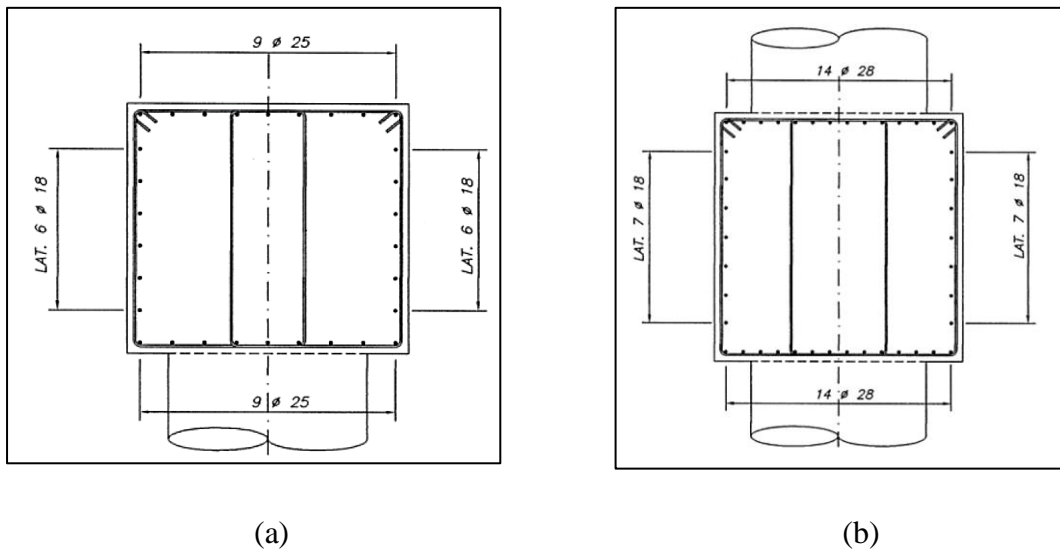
(a) Detalle Armadura Viga Cabezal. (b) Detalle Armadura Viga Fundación.
